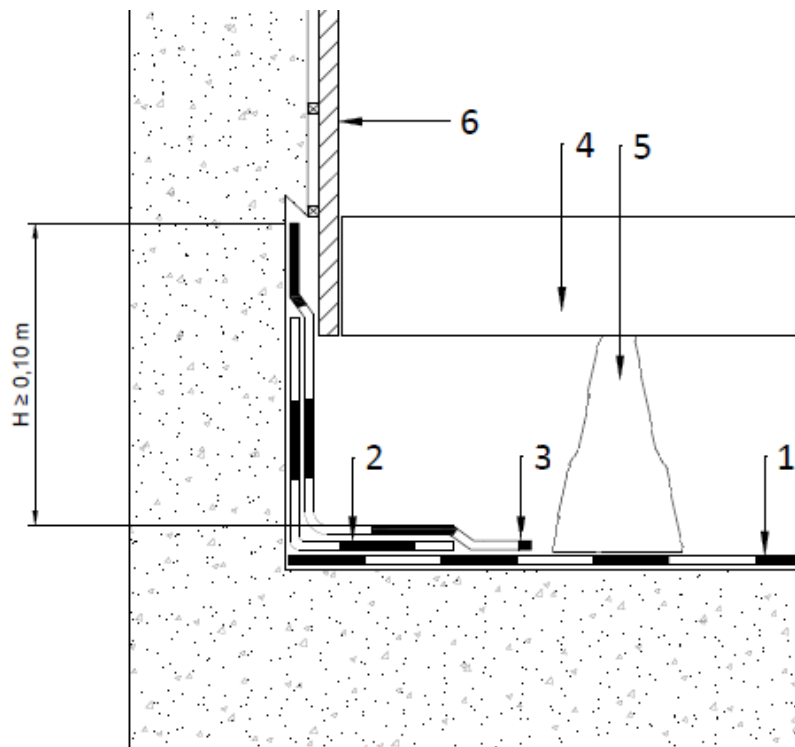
Coupe sur la bande de pontage des joints sur support maçonnerie pente nulle
